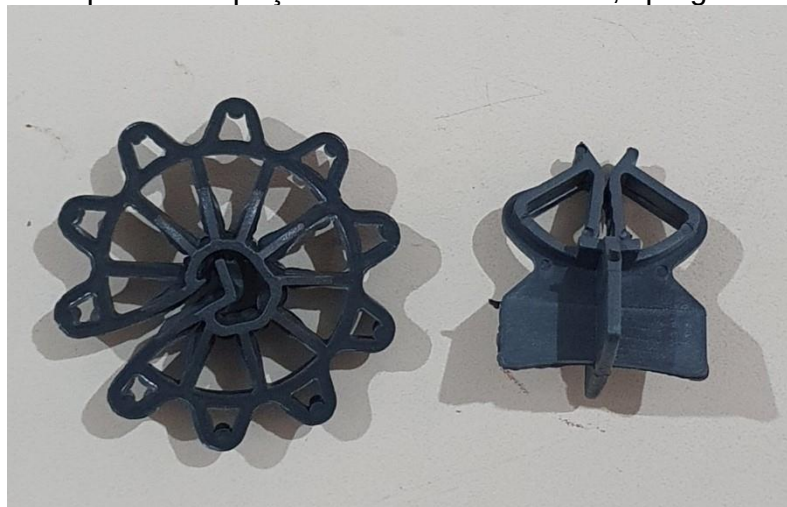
Espaçador aplicado na armadura mais exposta do pilar
